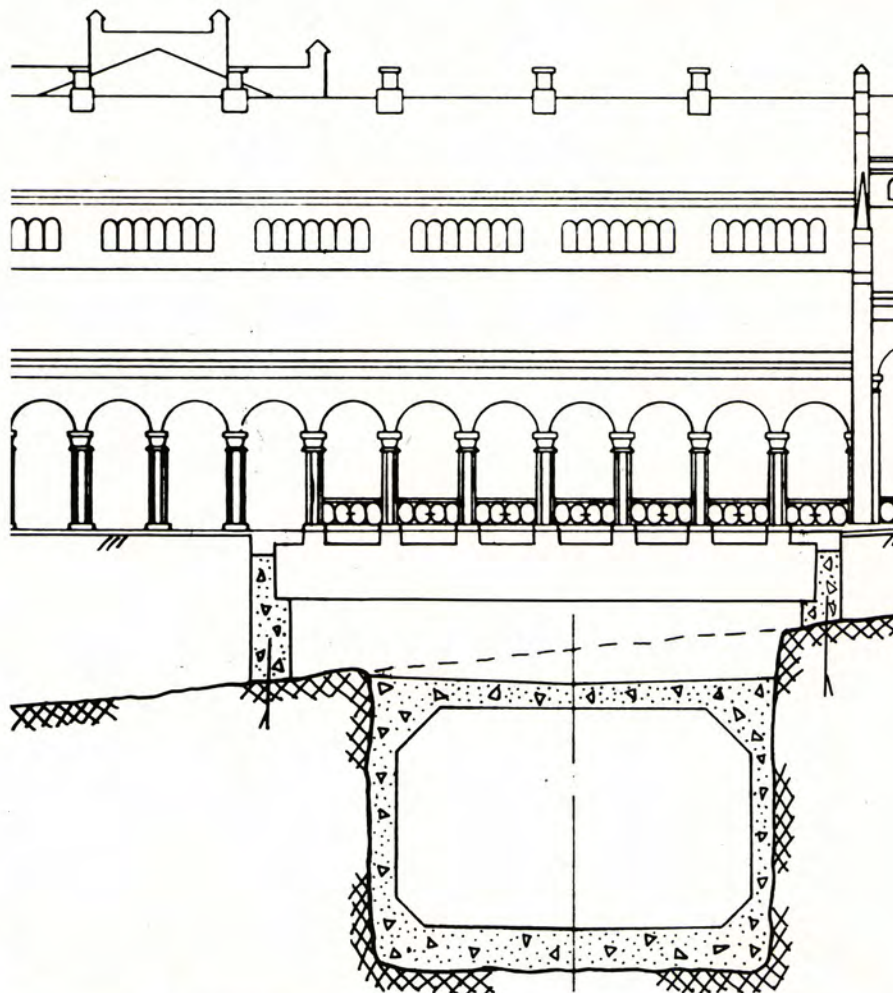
Midlertidig understøttelse av Basarhallene ved Domkirken mens tunnelarbeidene pågår.
